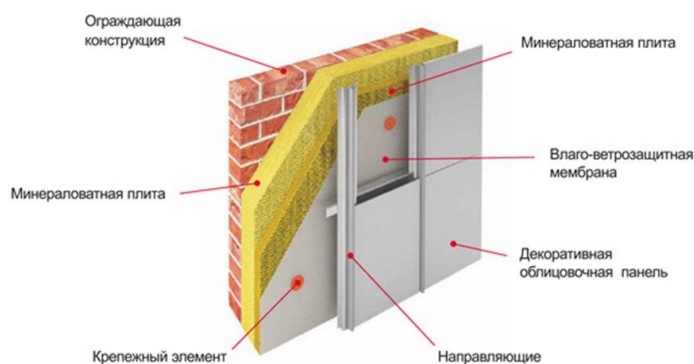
Устройство навесного вентилируемого фасада
